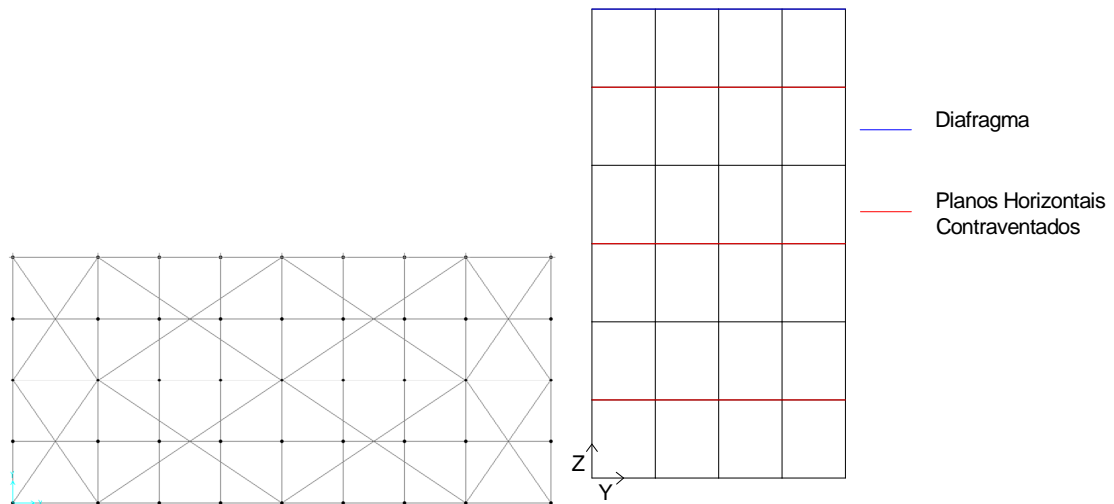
Configuração dos Planos de Contraventamento Horizontal Com Elementos de Contraventamento Grandes
